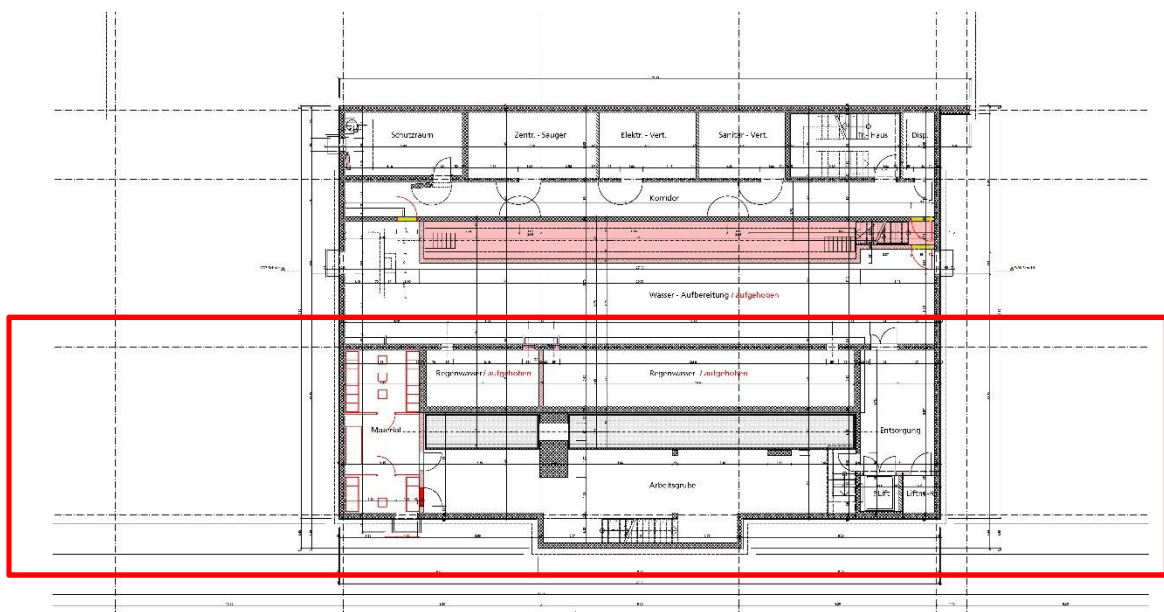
Grundrisslayout Prüfhalle 3, Untergeschoss (prov. Skizze)
